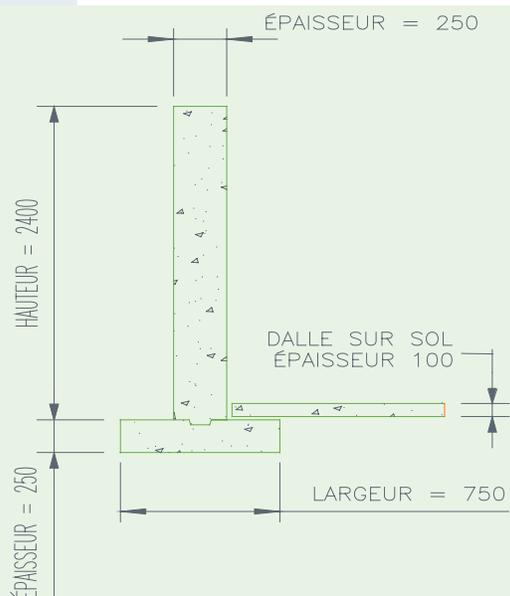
Dimension de la semelle et du mur (vue en coupe)
